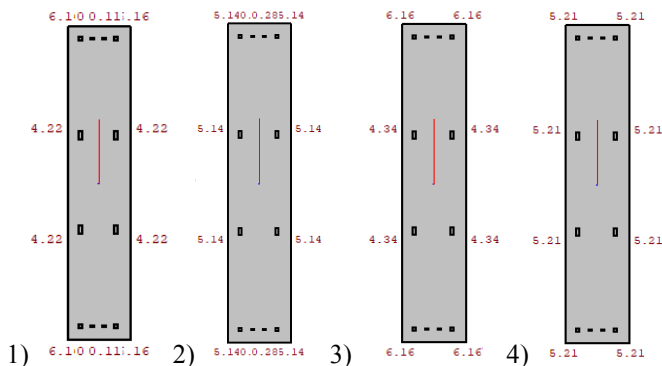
Схема распределения площади арматуры в сечении стержня при виде армирования «Колонна» (1, 2) и «Пилон» (3, 4)
